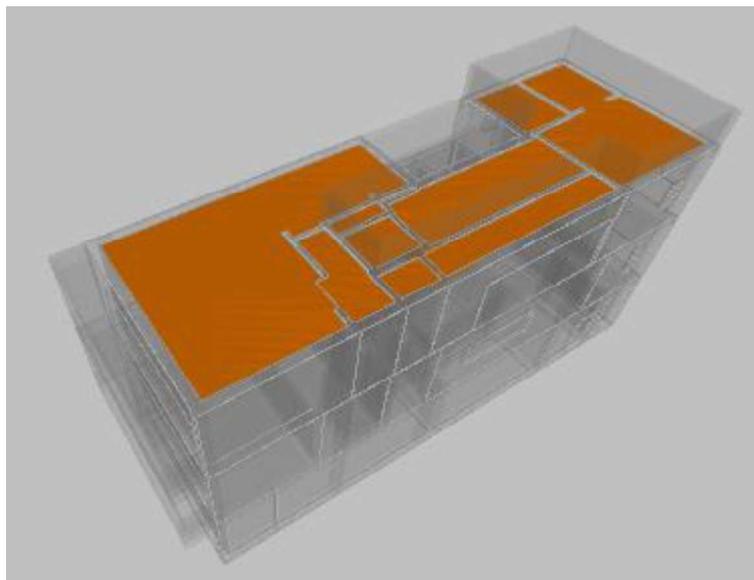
Situación de la Azotea de la Planta Cubierta en la vivienda. CYPETHERM HE Plus
